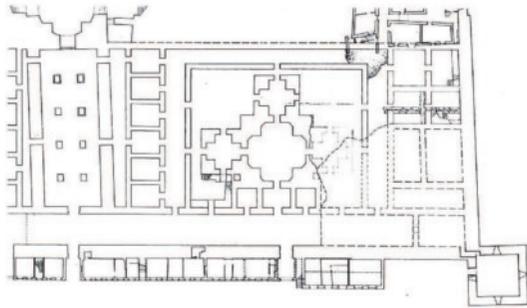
, Der südöstliche Teil des Palastes - Grundriss Kellergeschoß
